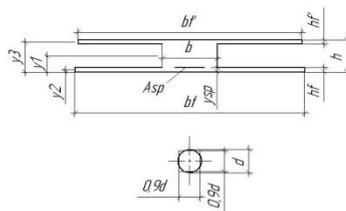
Приведённое двутавровое сечение плиты перекрытия и приведение круглого отверстия к квадратному
